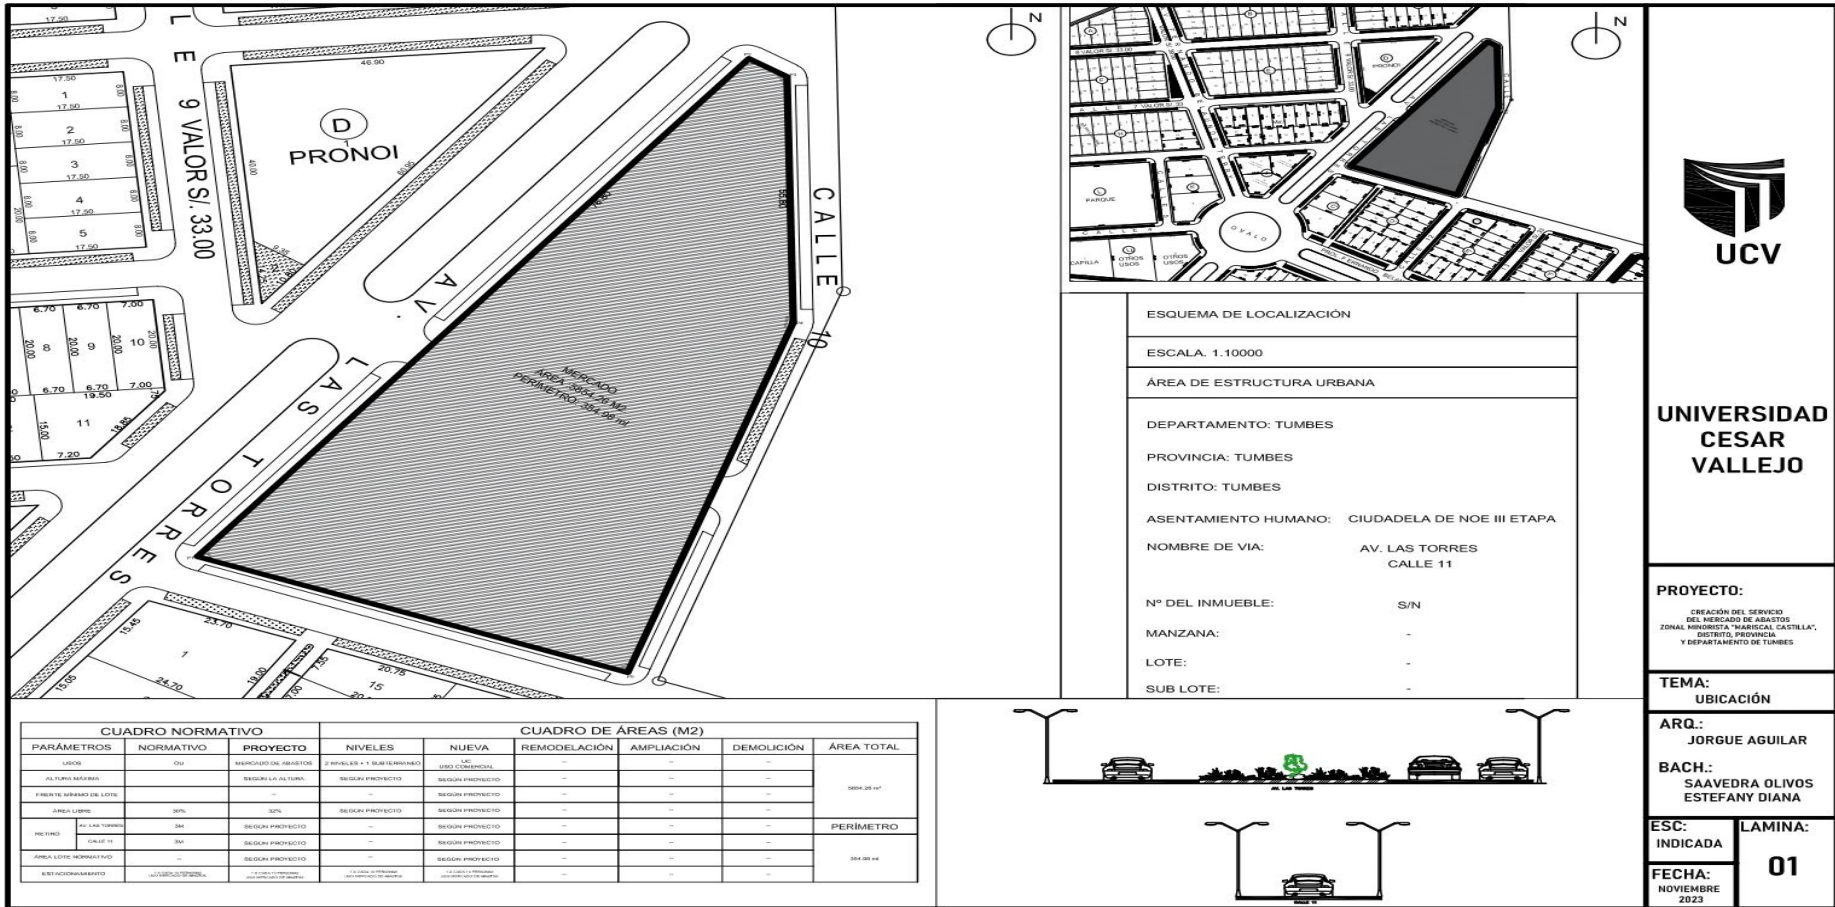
Plano de ubicación y localización. Fuente: Elaboración propia.
